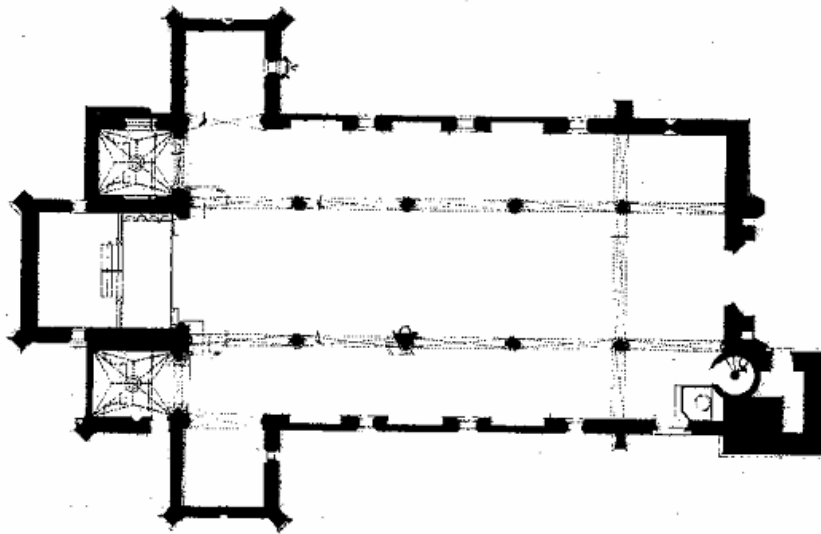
Planta da igreja Matriz de Vila do Conde [3]
